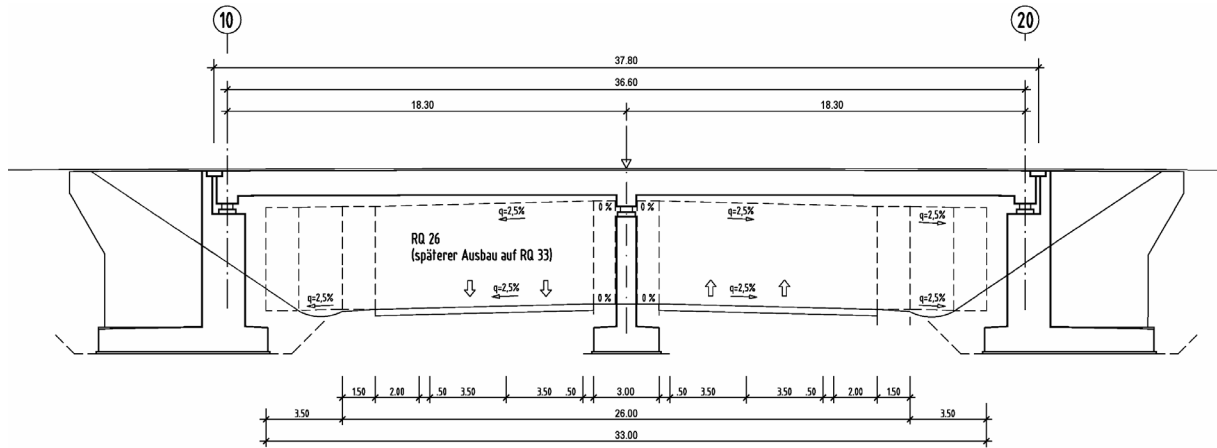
Integrale Stahlbetonbrücke in Ortbetonbauweise
